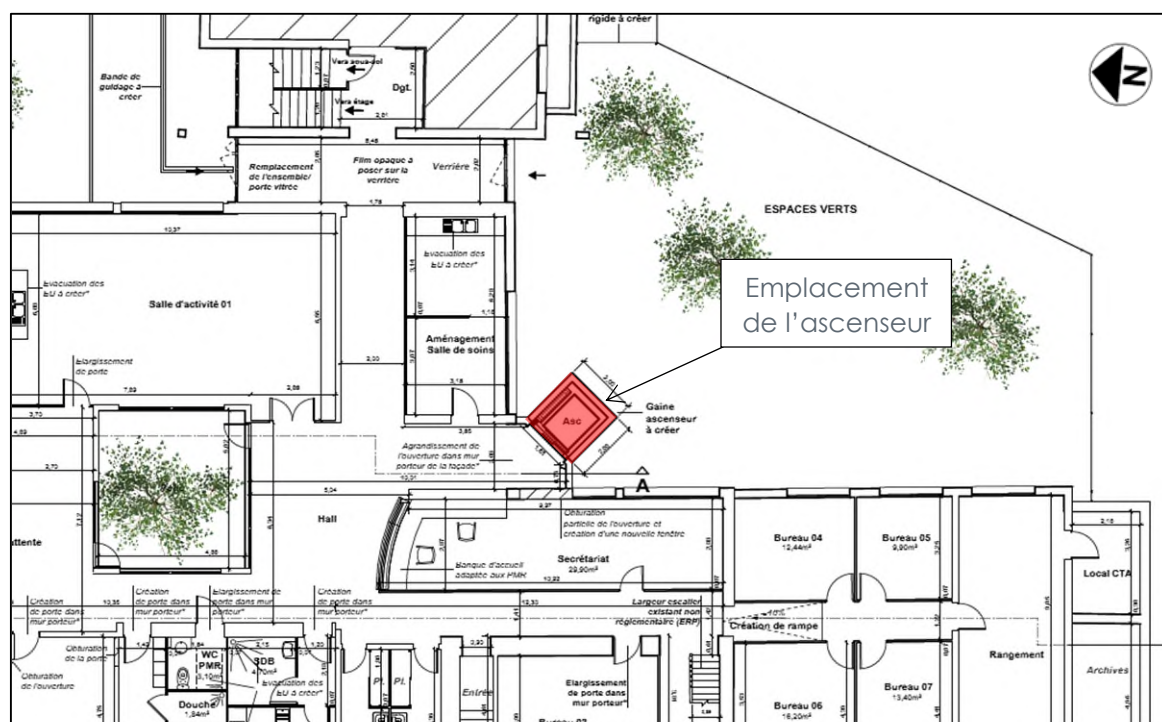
Plan du rez-de-chaussée (source EPSMM, octobre 2023)
